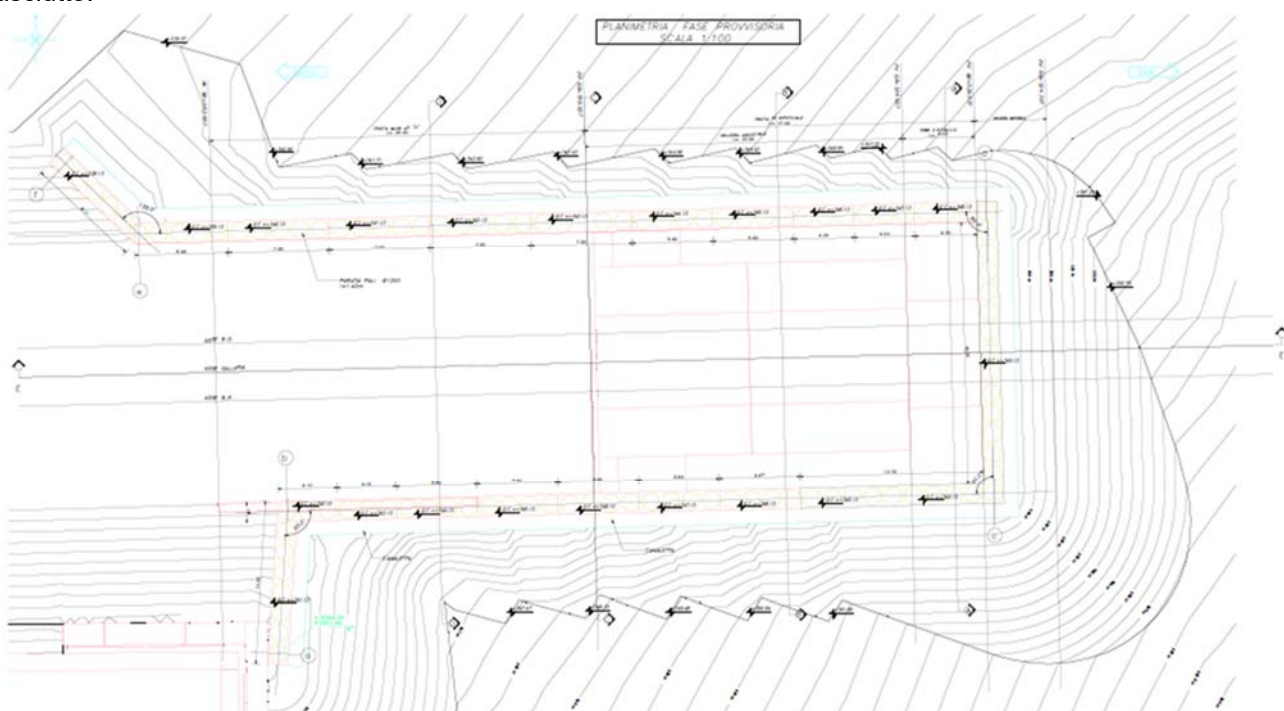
Planimetria delle opere di imbocco della galleria Hirpinia lato Napoli – Fase provvisoria
